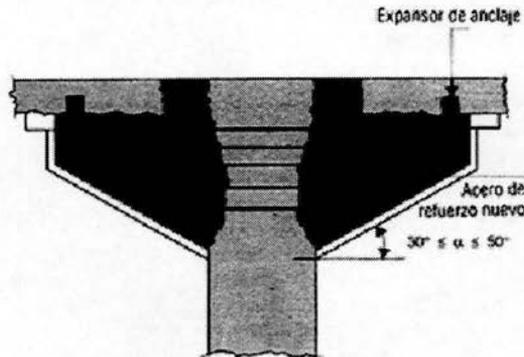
Refuerzos columnas / losas– Punzonamiento
